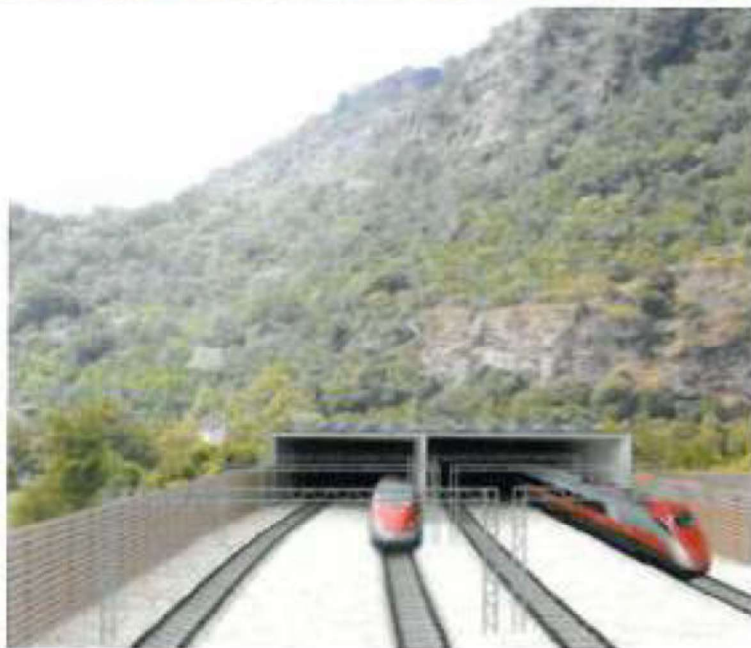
Fotoinserimenti dell'imbocco Est del Tunnel di Base
